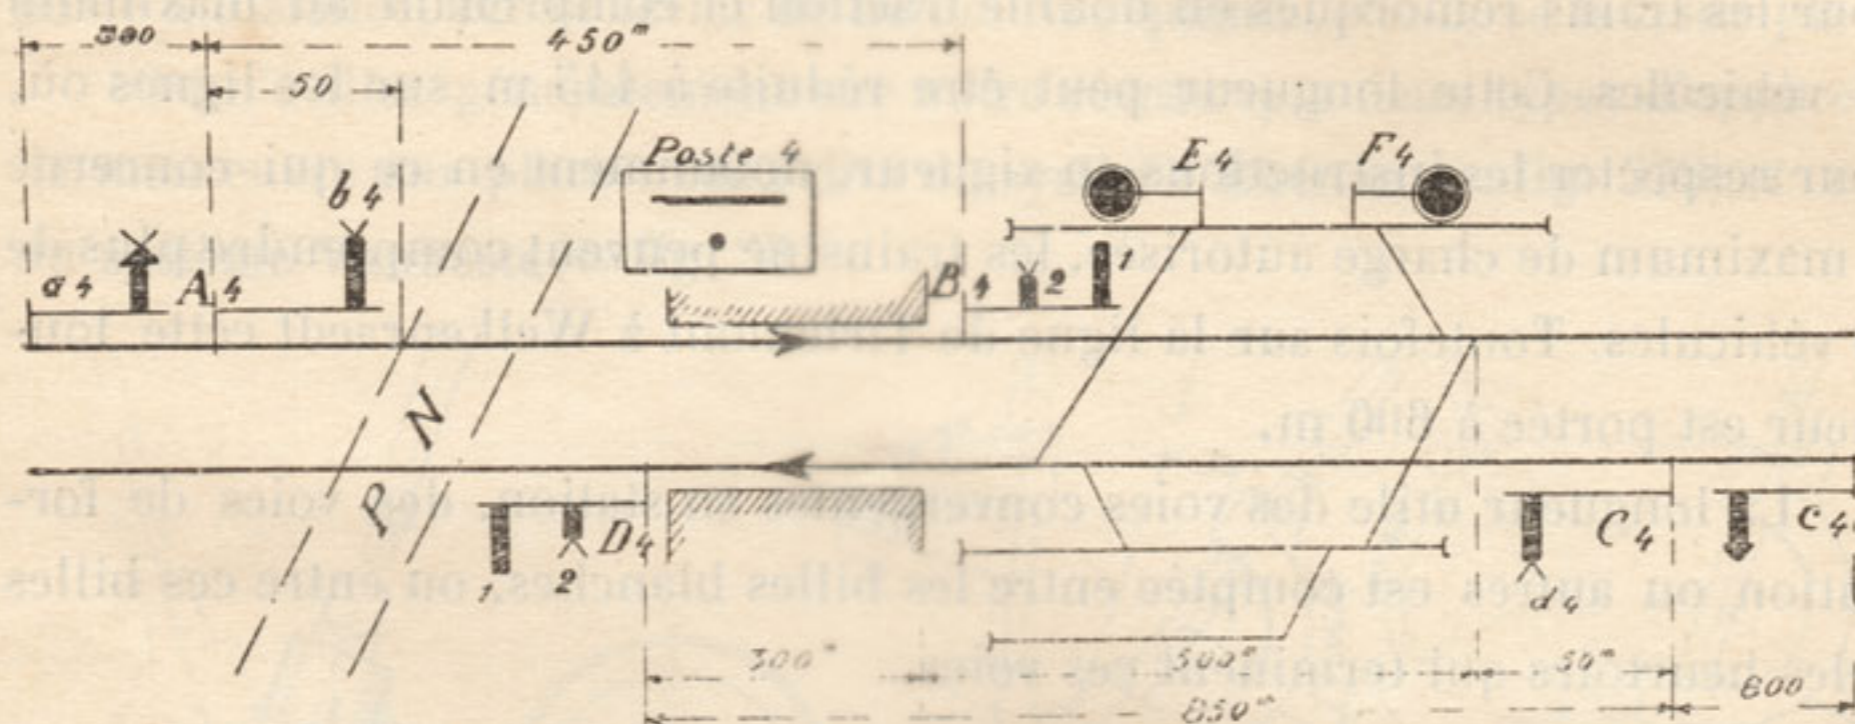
Disposition des voies d'une station intermédiaire servant au garage des trains par rebroussement.
